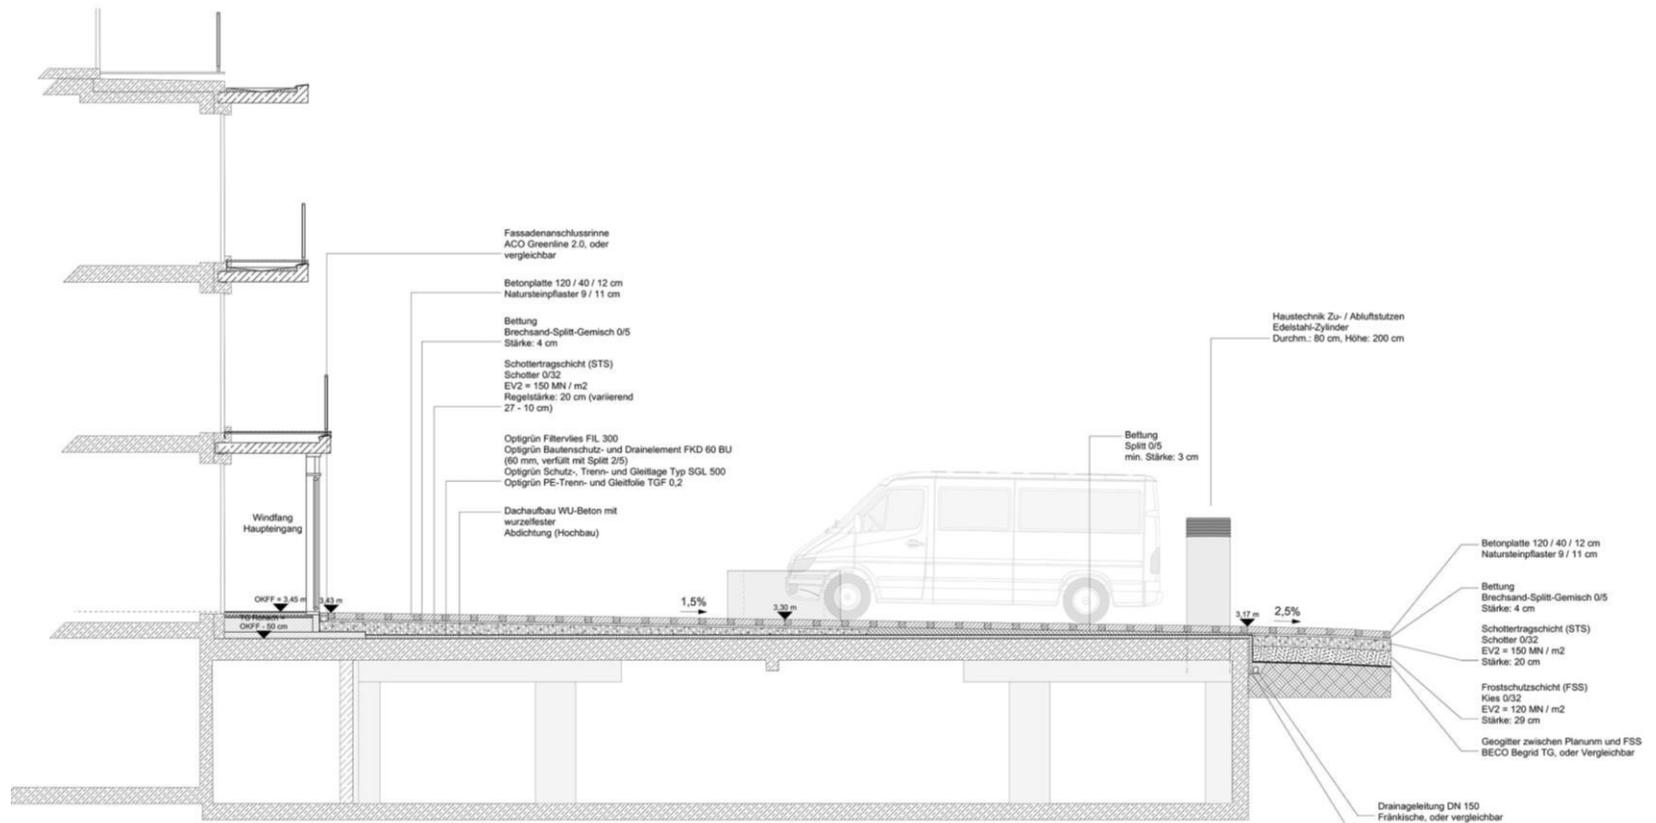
Wegeaufbau des Tiefgaragendaches
